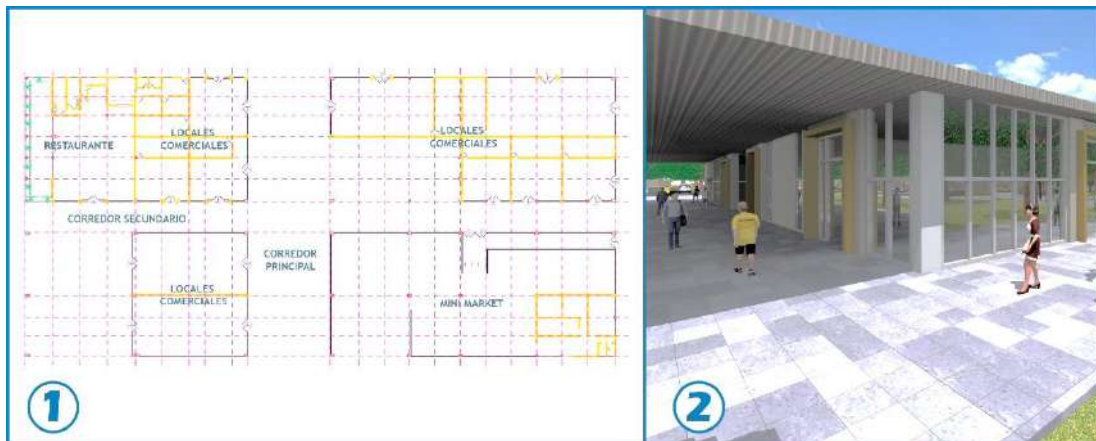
Planta comercial (estructuras), Vista exterior de zona comercial. Fuente: Elaboración propia.
